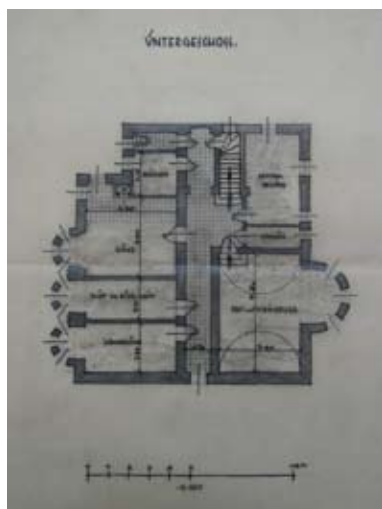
Plan 32.4: Anton Valentin. Untergeschoss. Grundriss Ohne Datierung.
